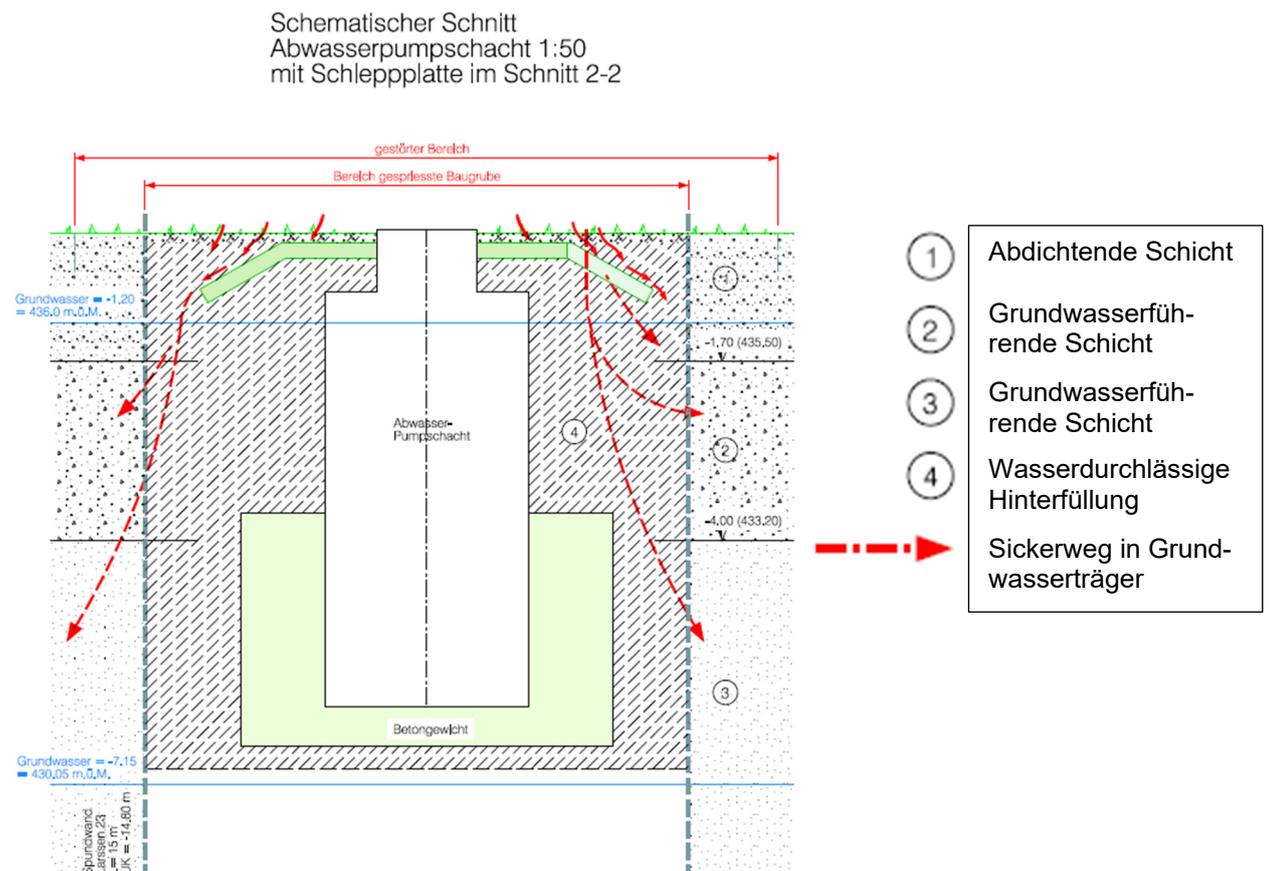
Schematische Darstellung der möglichen Sickerwege von Oberflächenwasser im Auffüllungsbereich der Baugrube für den Abwasserpumpschacht
